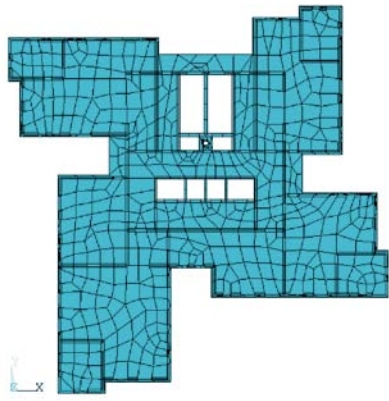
Сетка конечных элементов на перекрытии типового этажа
